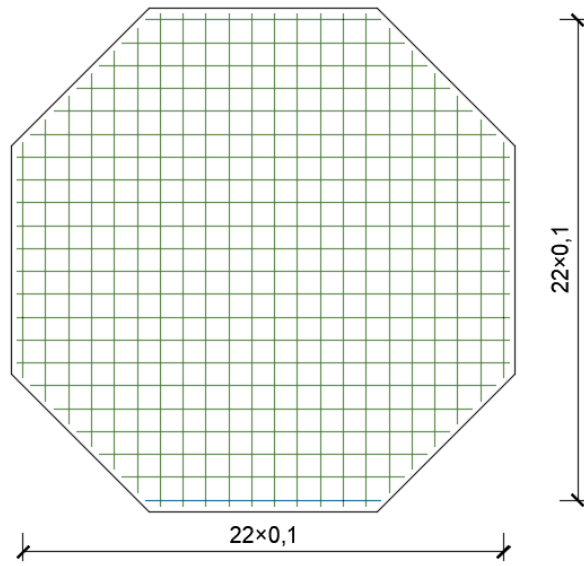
Pormenorização da armadura inferior (varões com $\phi 10$) com cotas em m
